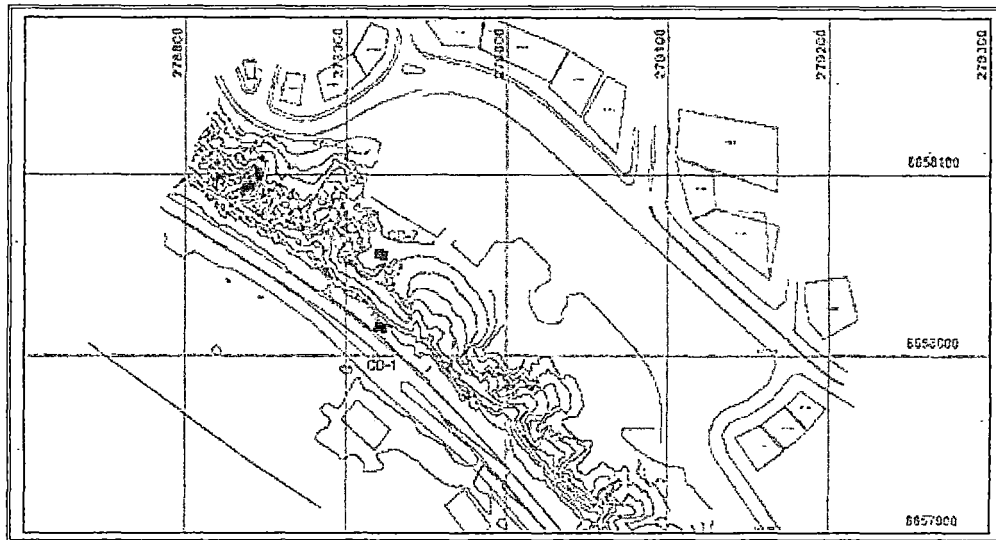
Plano en planta con la ubicación de los ensayos de corte directo in-situ
